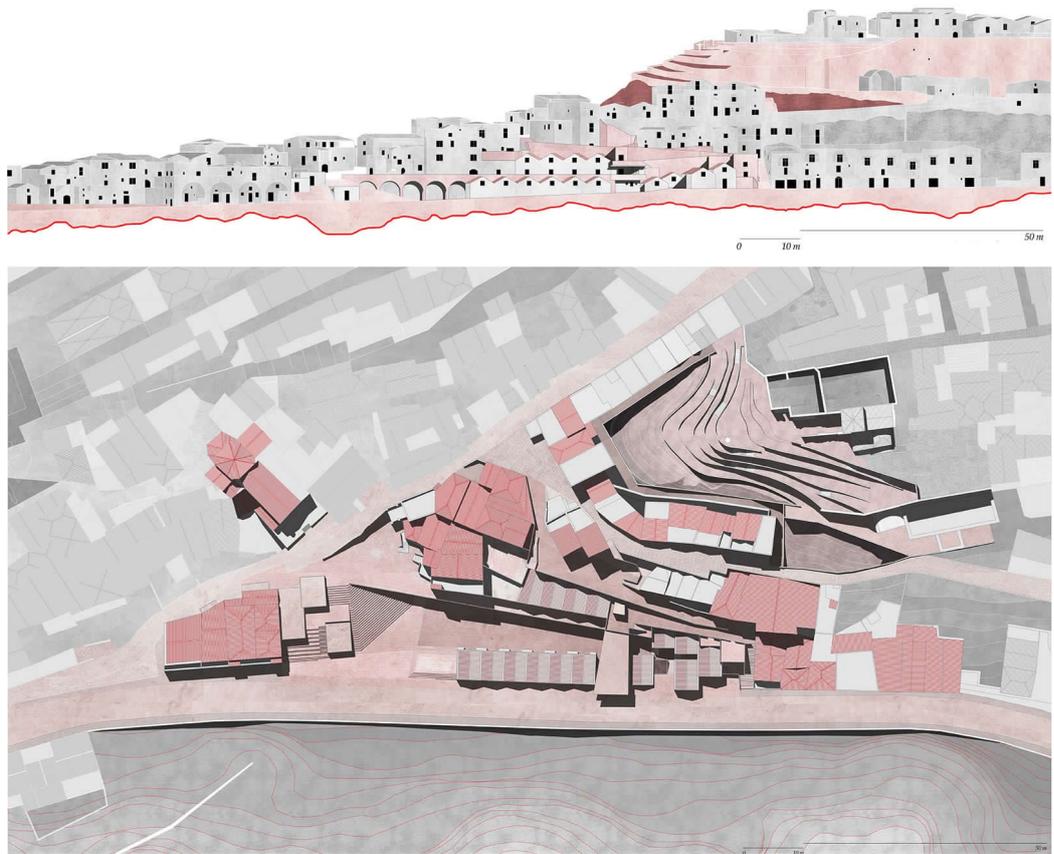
Elaborati progettuali. Profilo longitudinale; planimetria generale di progetto.
